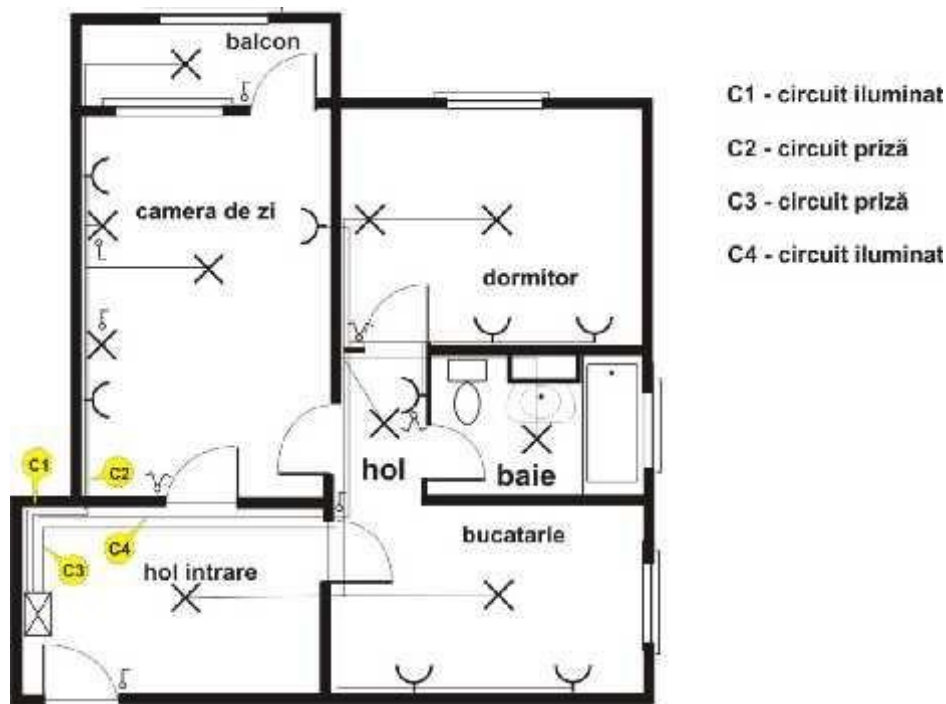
Plan de execuție pentru o instalație electrică de iluminat
